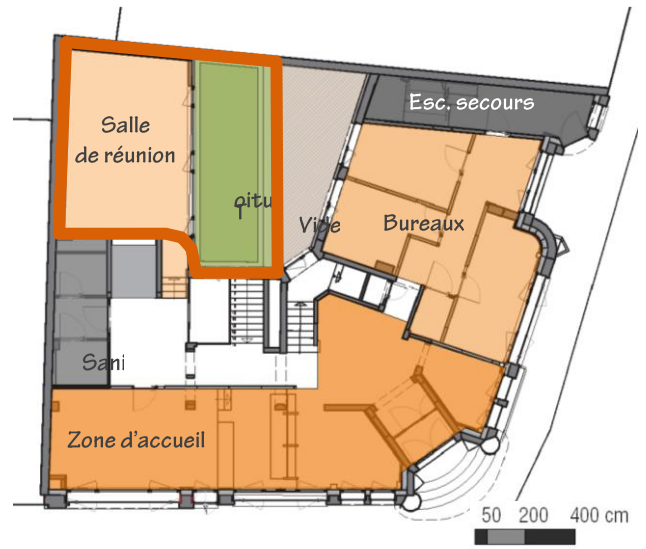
Plan du rez-de-chaussée (Source : Bureau A2M, 2011)
